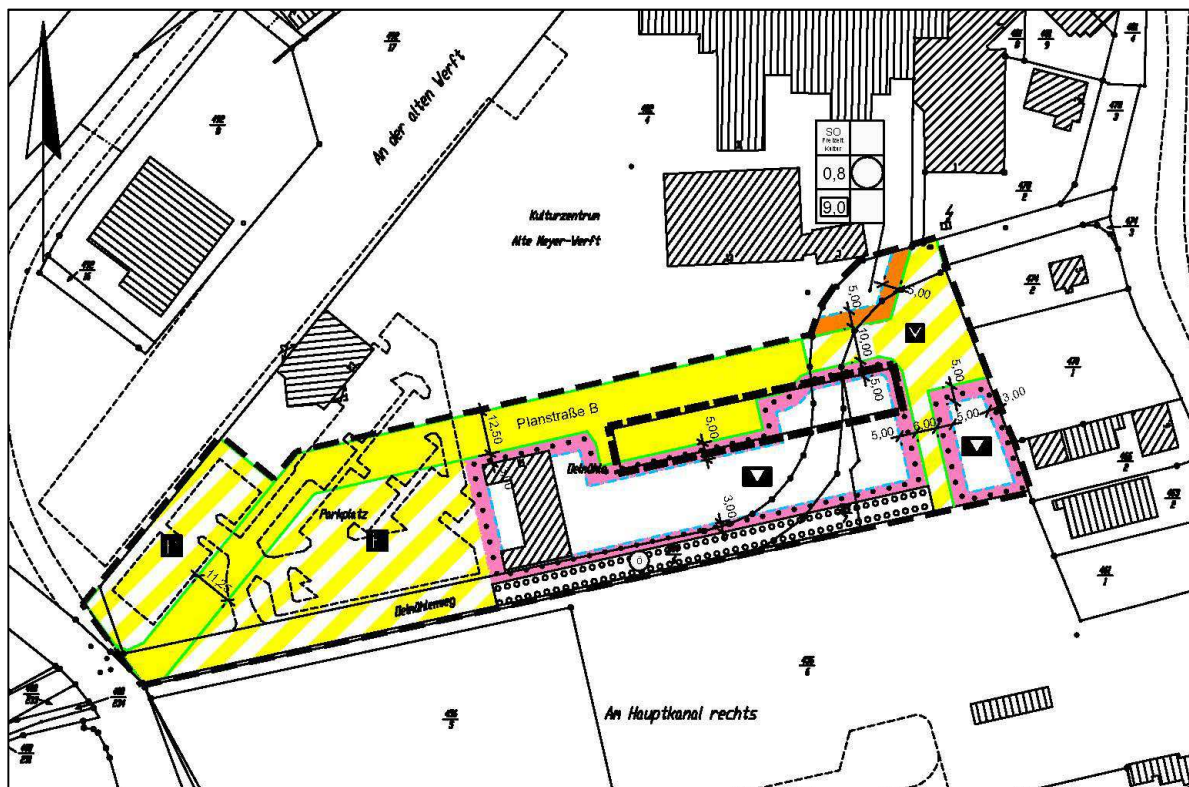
BPlan Nr. 219/I mit Geltungsbereich vBPlan Nr. 47
